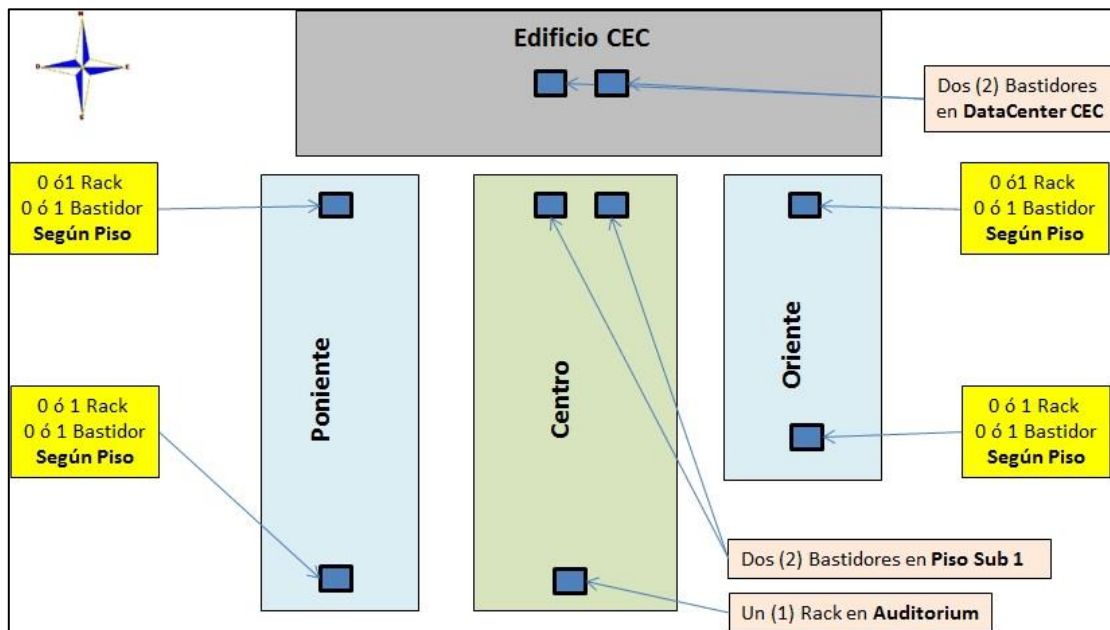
Vista de Planta Distribución de Gabinetes
